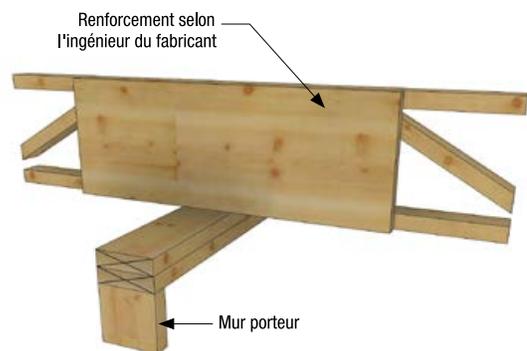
• Poutrelle en porte-à-faux avec un renforcement
